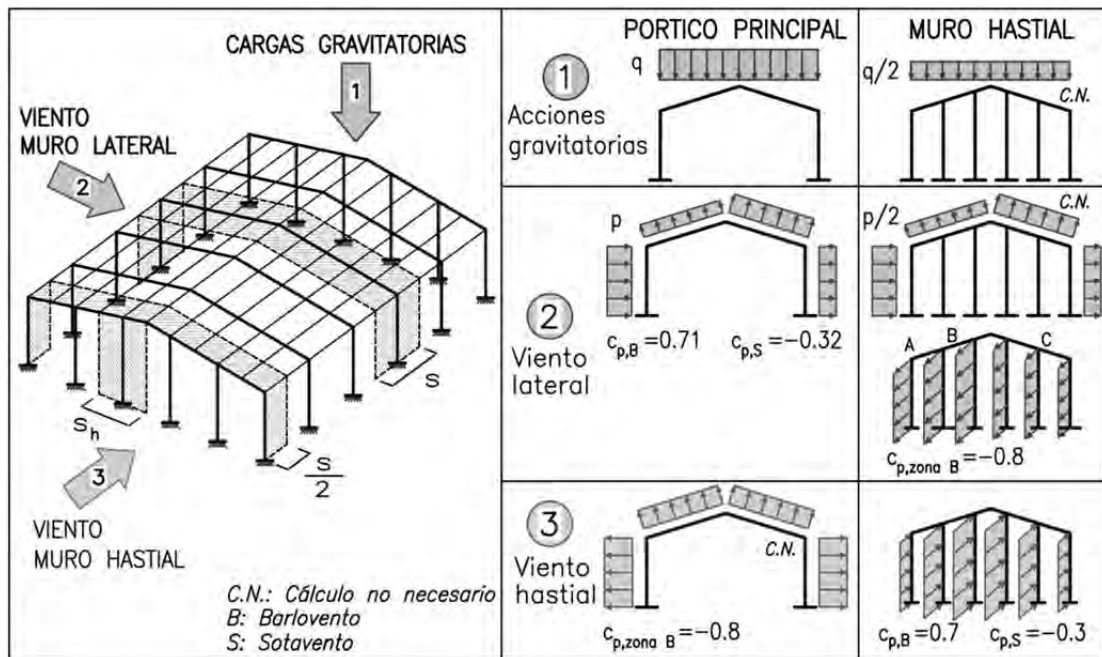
Distintas formas de actuación de las cargas sobre una nave. Las separaciones entre pilares se consideran fijas en cada fachada: s : fachada lateral ; s_h : fachada hastial
